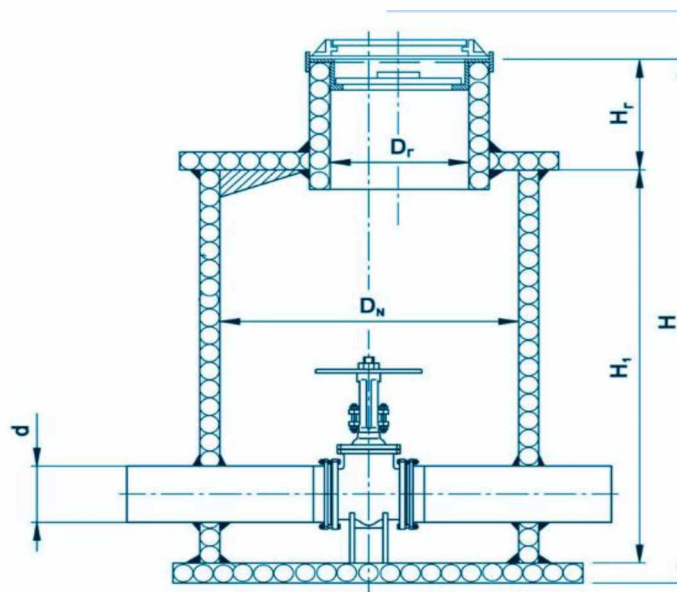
Схема поліетиленового водопровідного колодязя зі стільниковою будовою стінки та встановленою арматурою
